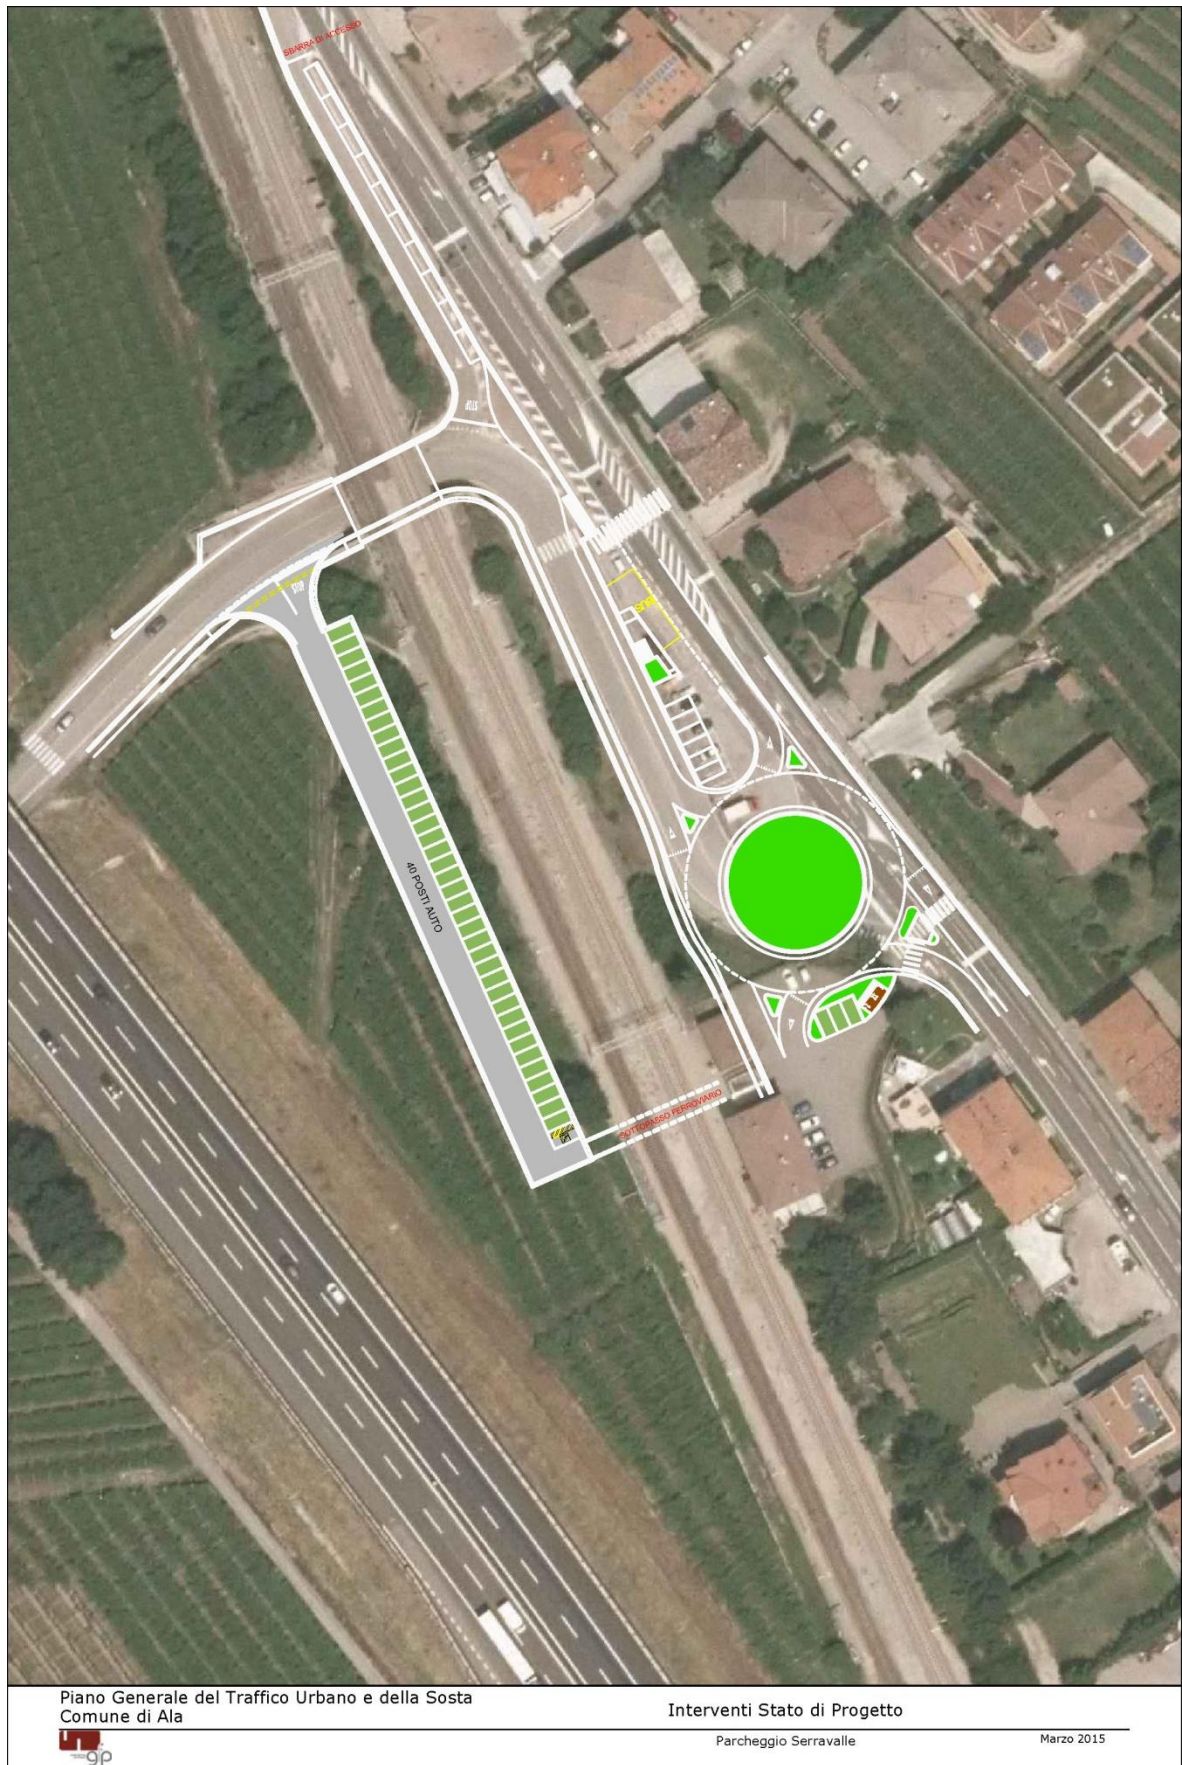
Interventi Stato di Progetto – Lungo Termine Parcheggio Serravalle
